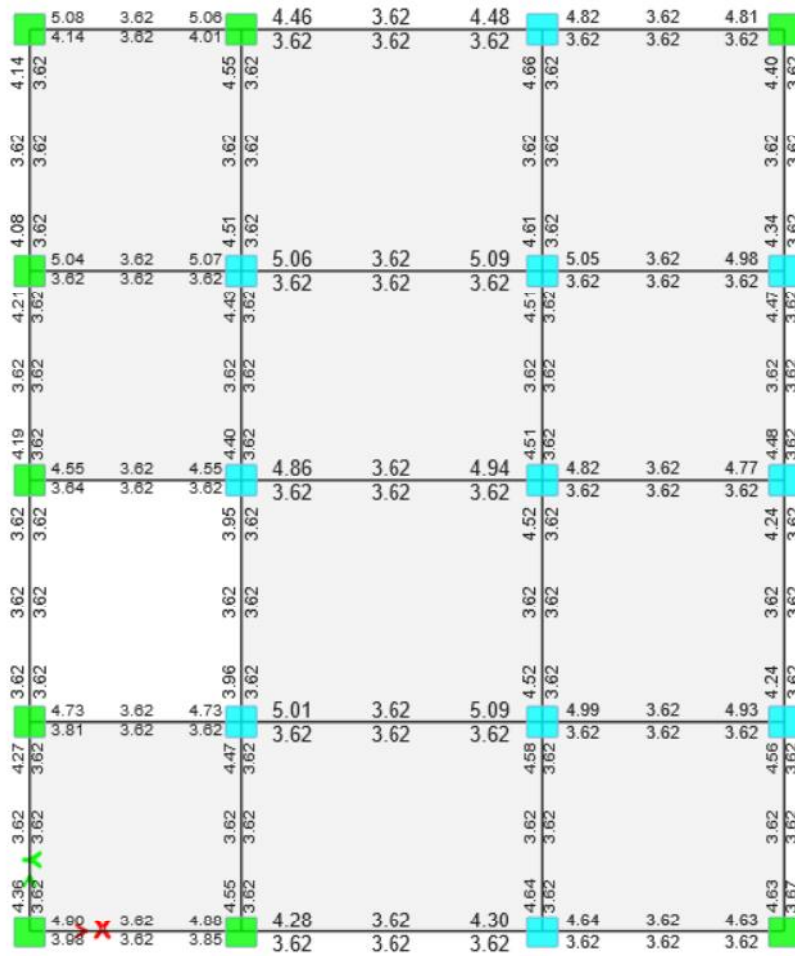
Refuerzo Longitudinal Vigas cm^2 – Losa $Nv+2.70\text{ m}$ – Estructura 5 Pisos
